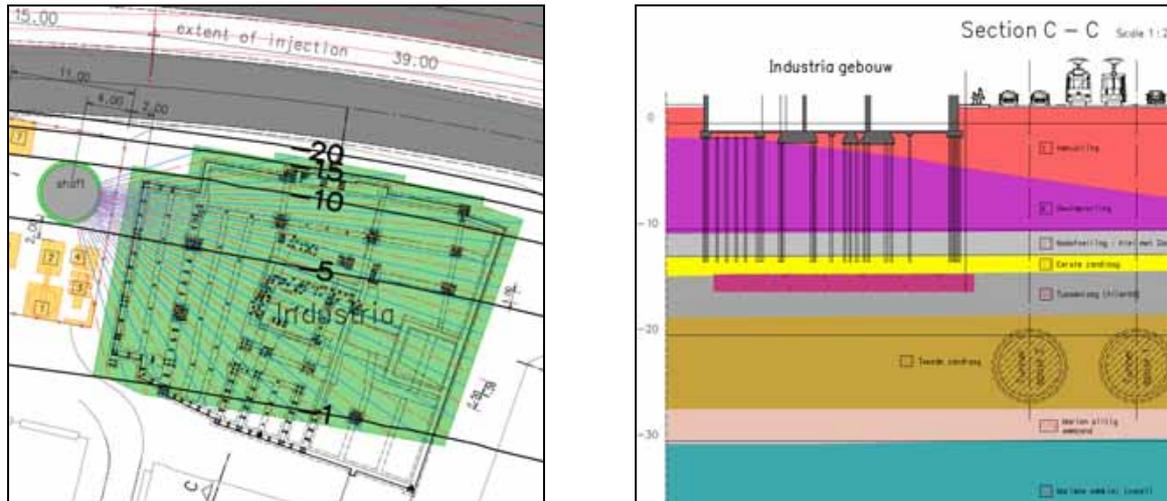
Grundriss und Querschnitt der Kompensationsinjektion unter dem Industria-Gebäude
